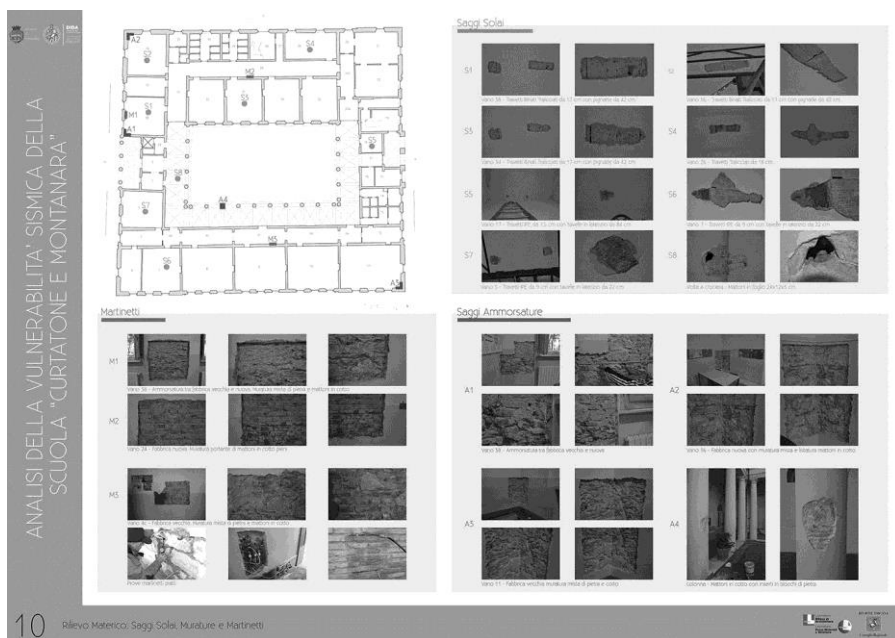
, Pianta piano terra, individuazione dei punti dove sono stati effettuati i saggi sulle murature.
